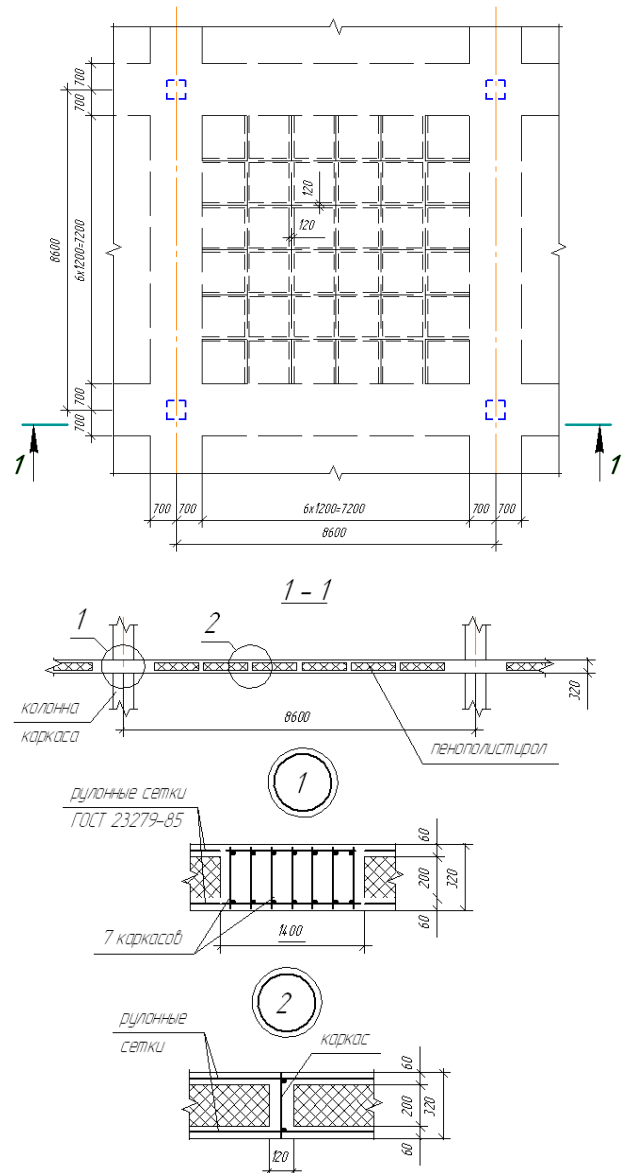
Фрагмент неразрезной плиты перекрытия.
